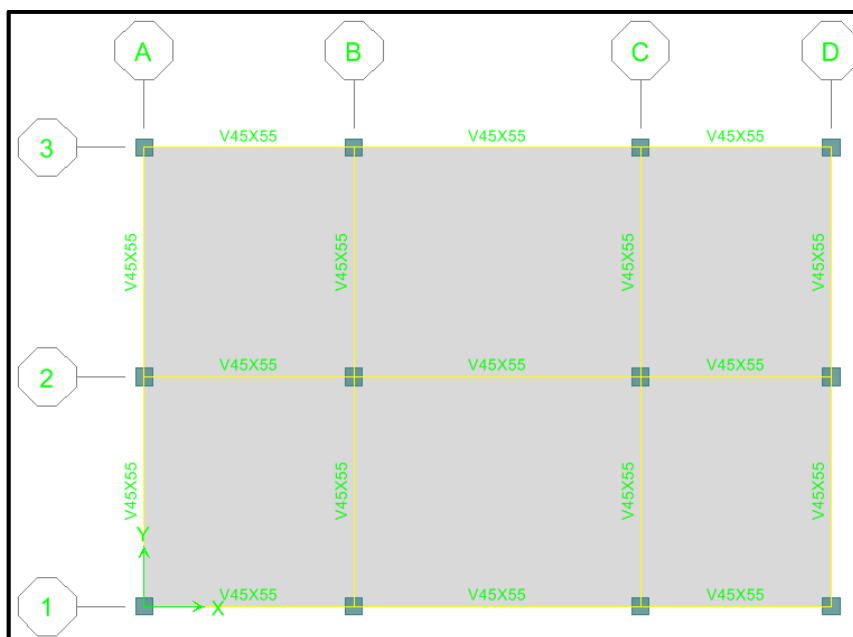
Secciones Finales de Vigas (Nivel Techo)
